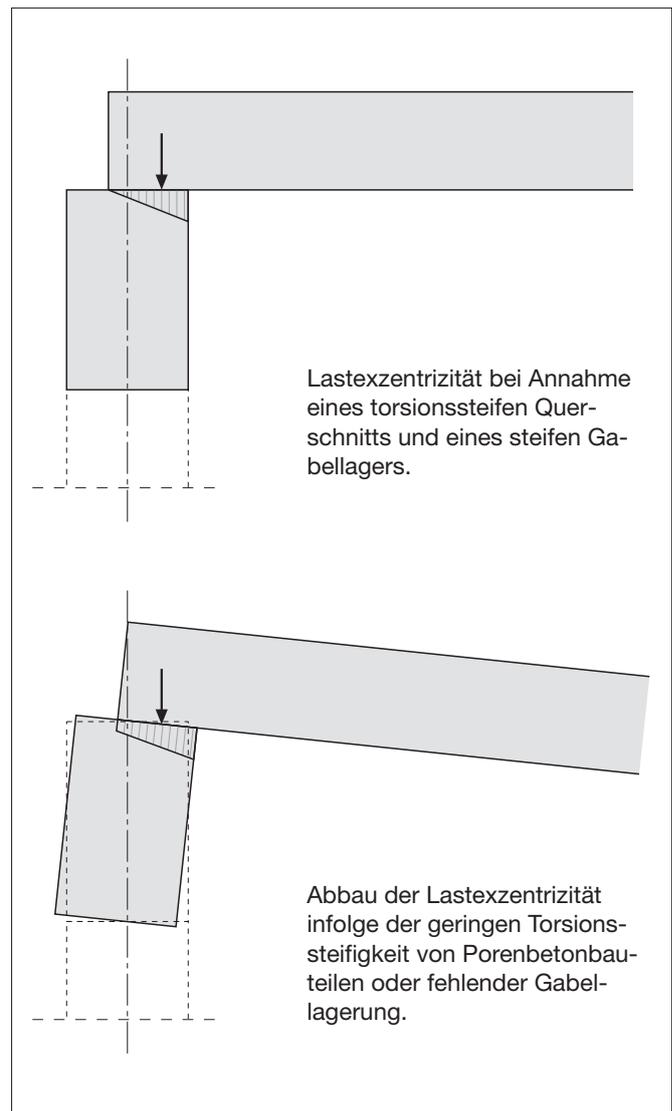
Außerzentrierte Belastung von Porenbetonbalken
